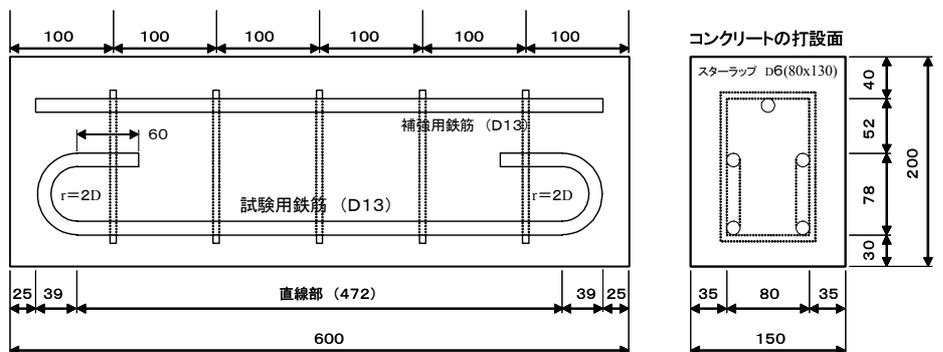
暴露試験体の形状と寸法(曲げ性状の検討, 単位: mm)
